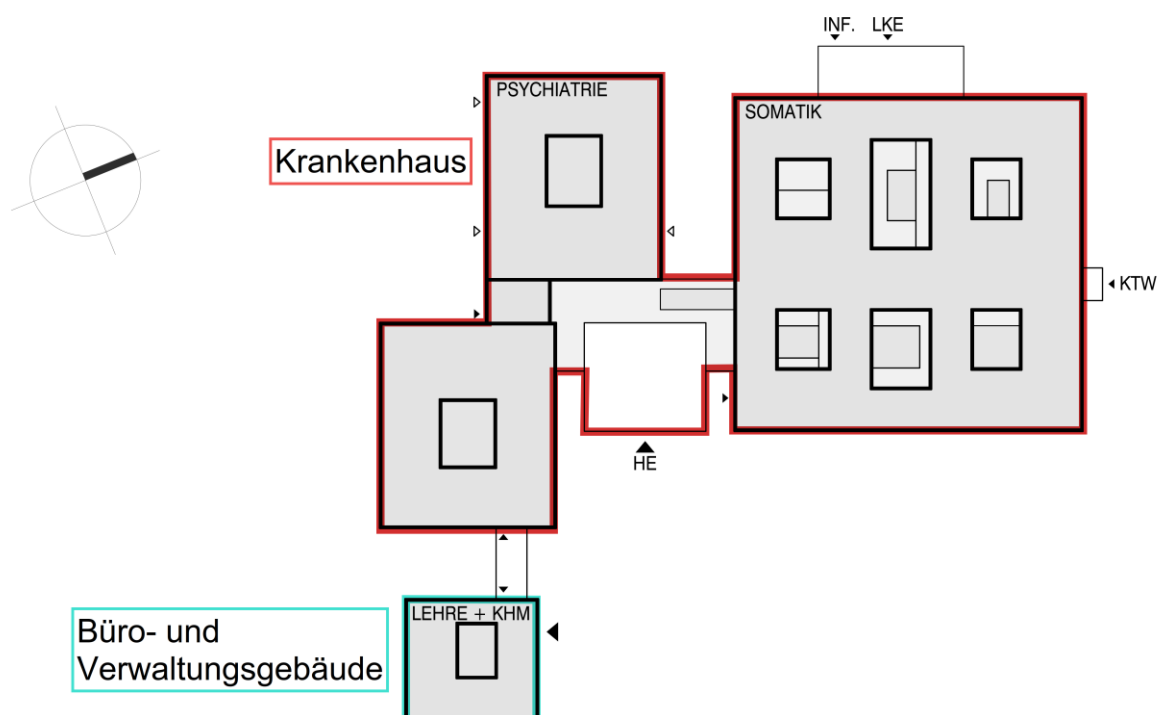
Darstellung der zwei Gebäudebereiche (Quelle: Grundriss, Übersichtsplan Ebene 00 von Ludes Architekten vom 15.08.2024)
